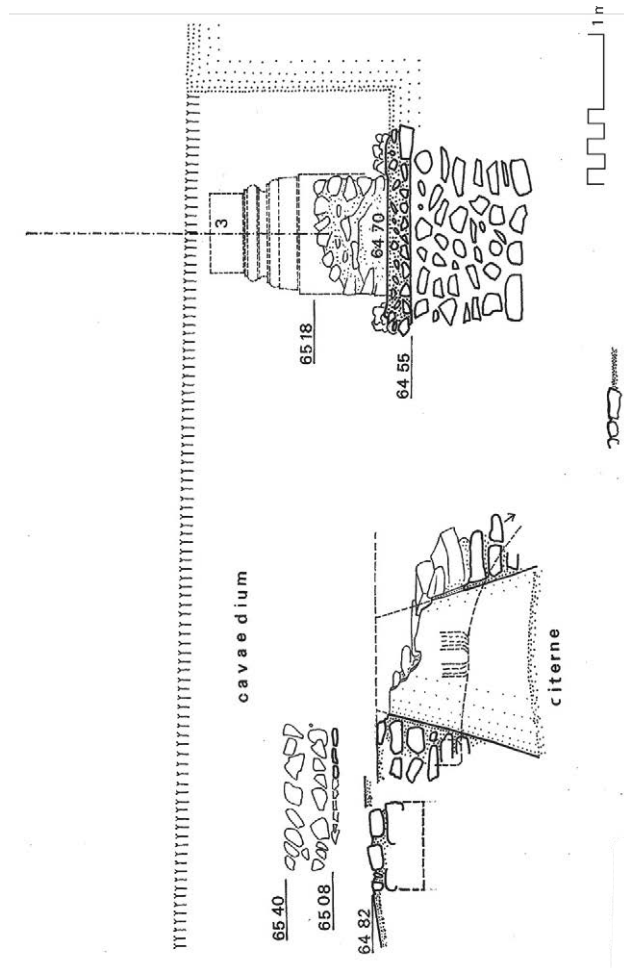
Coupe BB sur le portique est et la citerne, au droit de la colonne 3 (G. Hallier).
